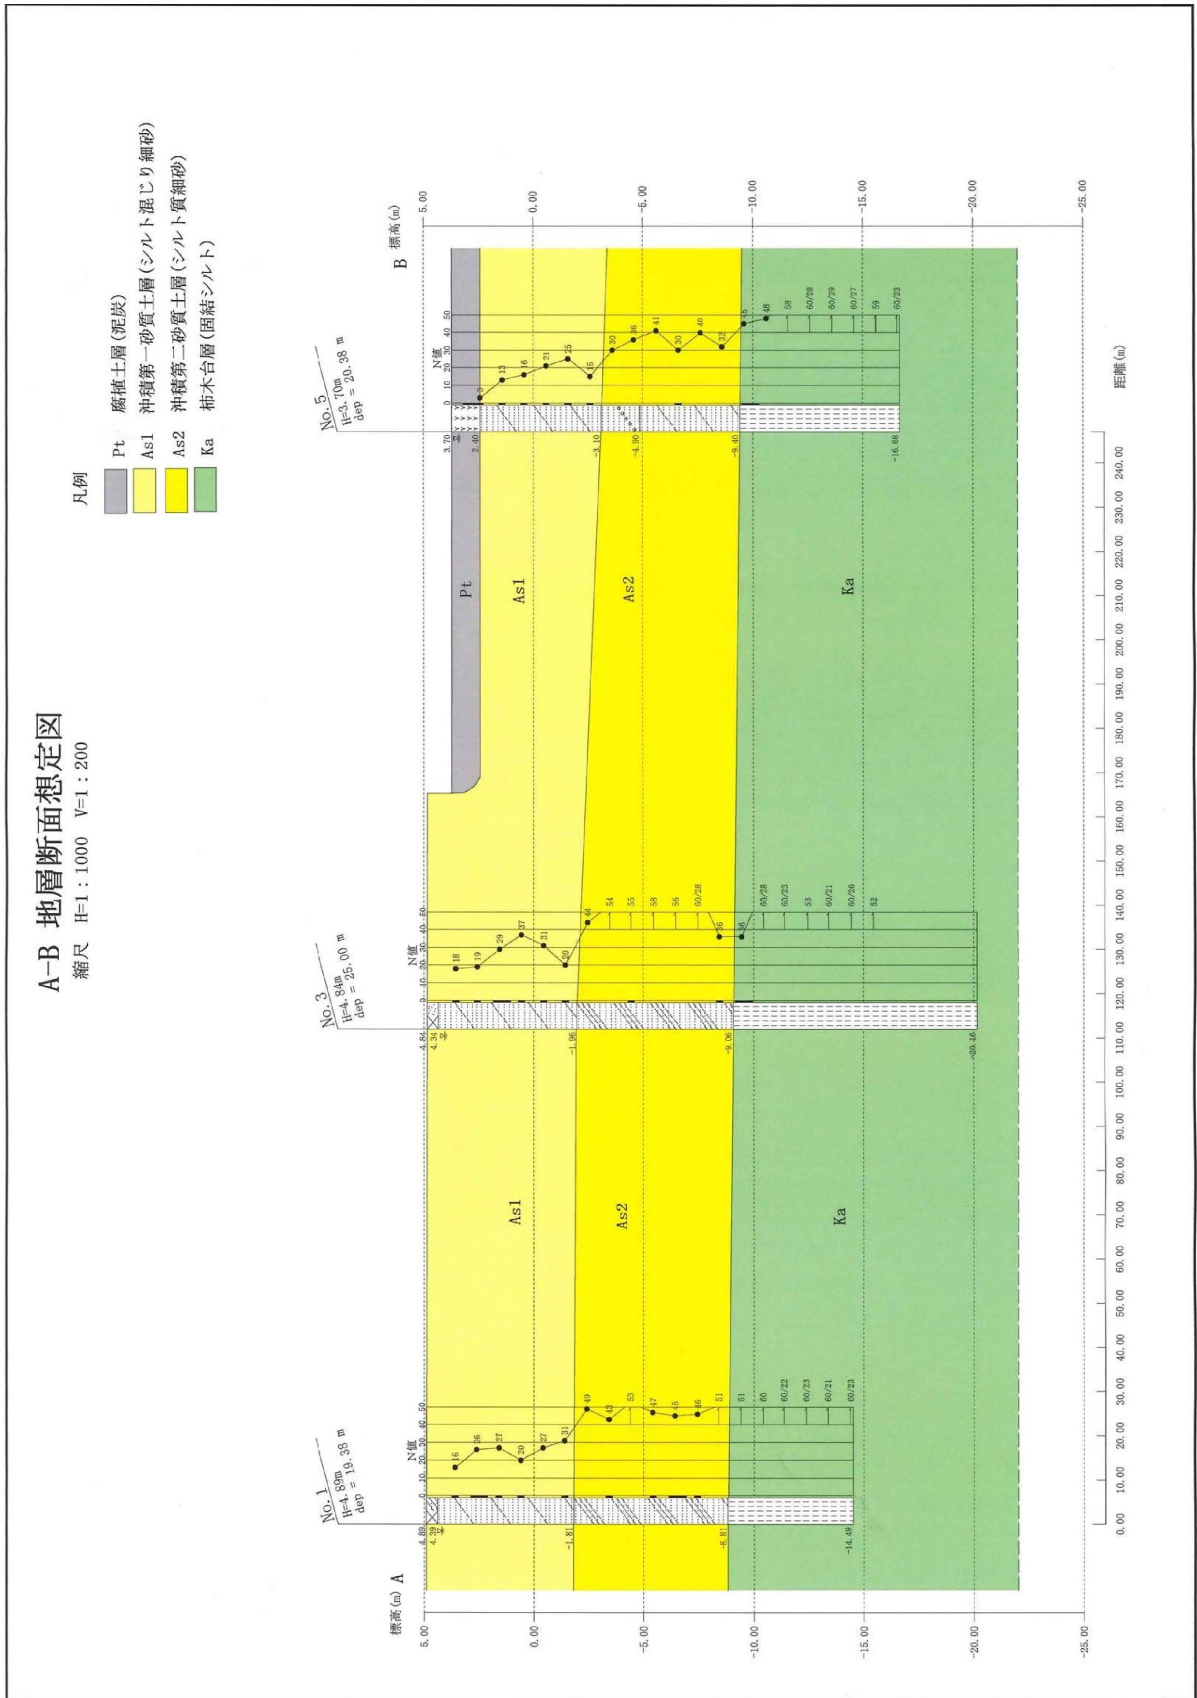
(1) 都市計画対象事業実施区域の地質想定断面図 (図 7.2.8-3 再掲)
